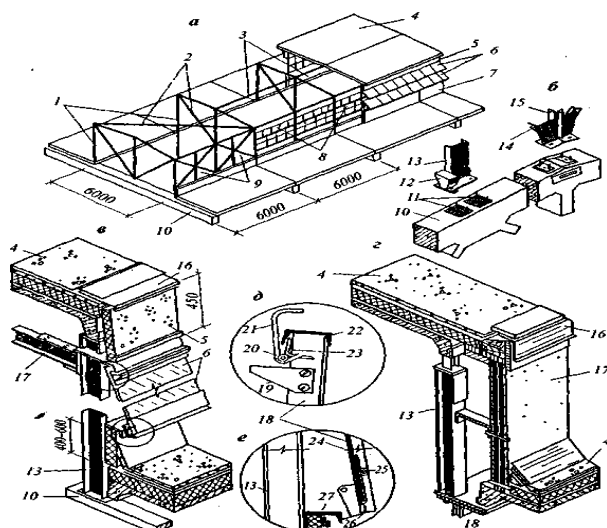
Конструкция прямоугольного светоаэрационного фонаря:
